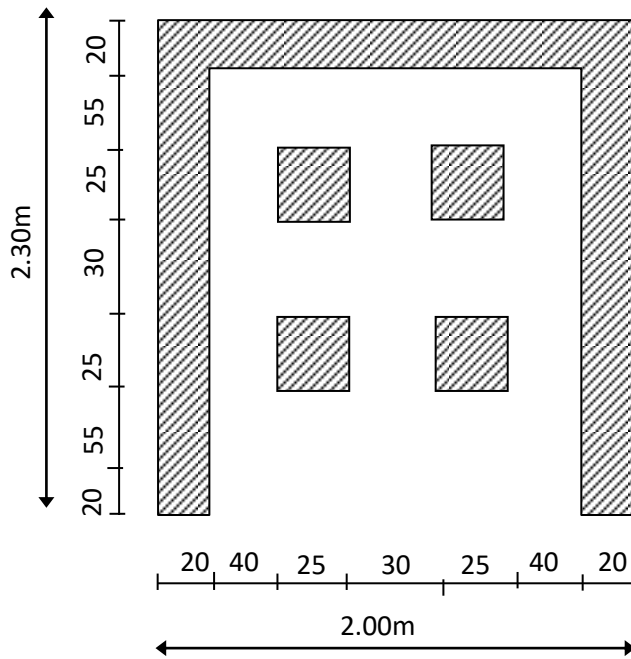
Schéma de la dalle pleine d'ascenseur.
